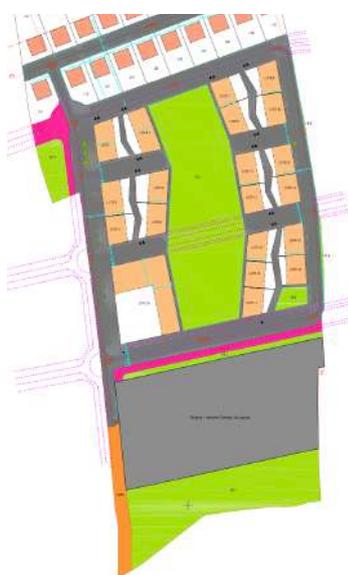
Planta síntese do Loteamento (apresentada com maior detalhe no capítulo 3.1).
